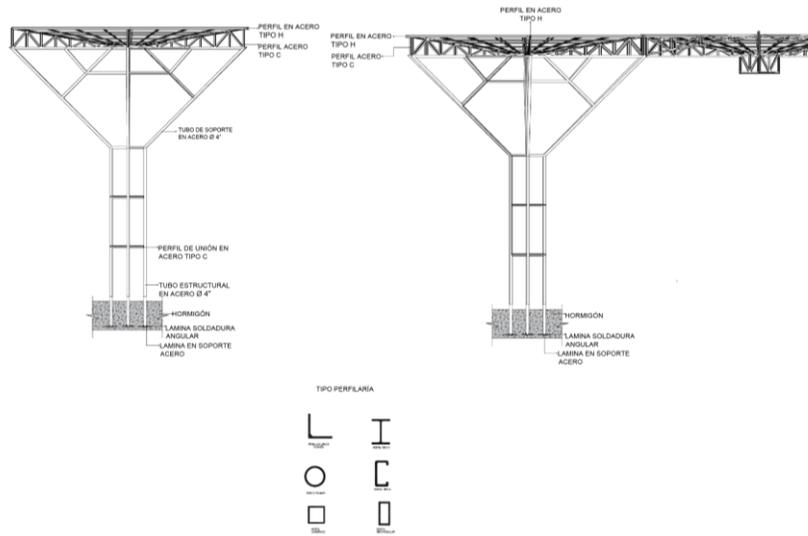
Detalles constructivos estructura; Fuente: Elaboración propia
